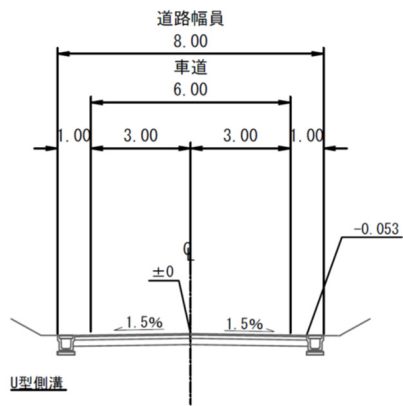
(4) 標準断面図(区画道路 8-1、2 幅員 8.0m)
